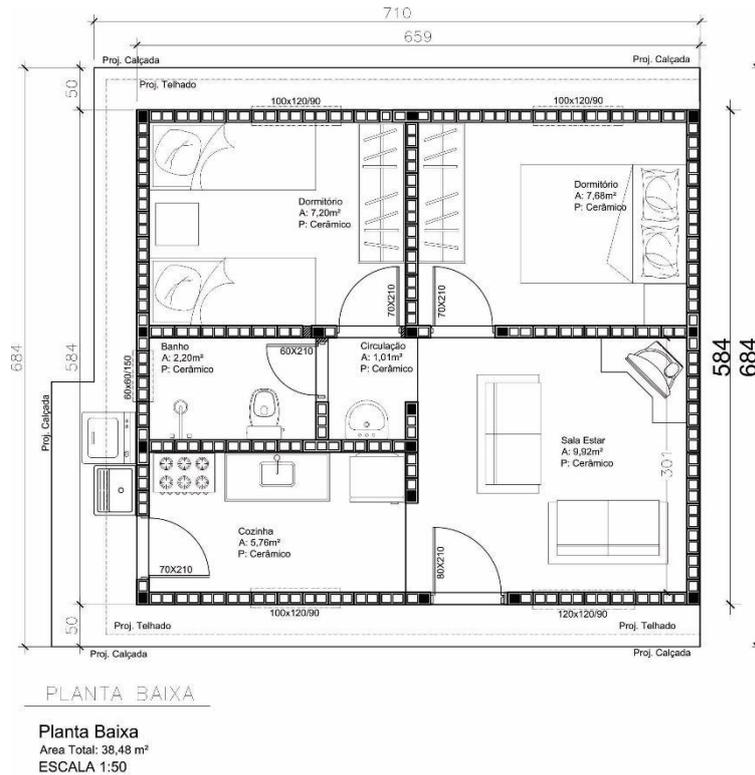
Planta Baixa das moradias do Conjunto Amanhecer II e Carlotto
